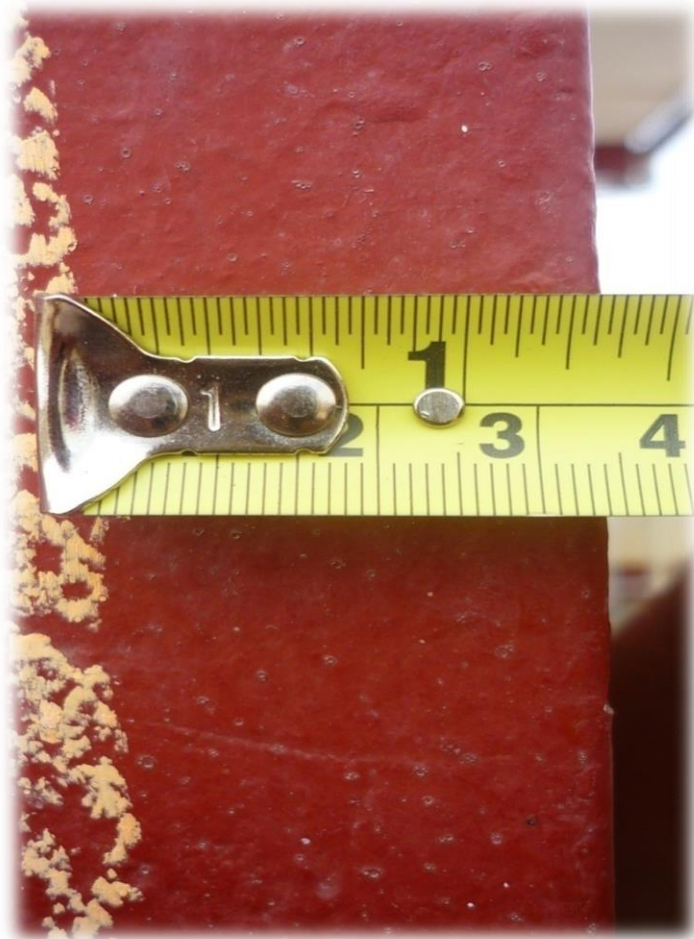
Medición con wincha del recubrimiento de concreto de la cara externa de la columna al acero.
